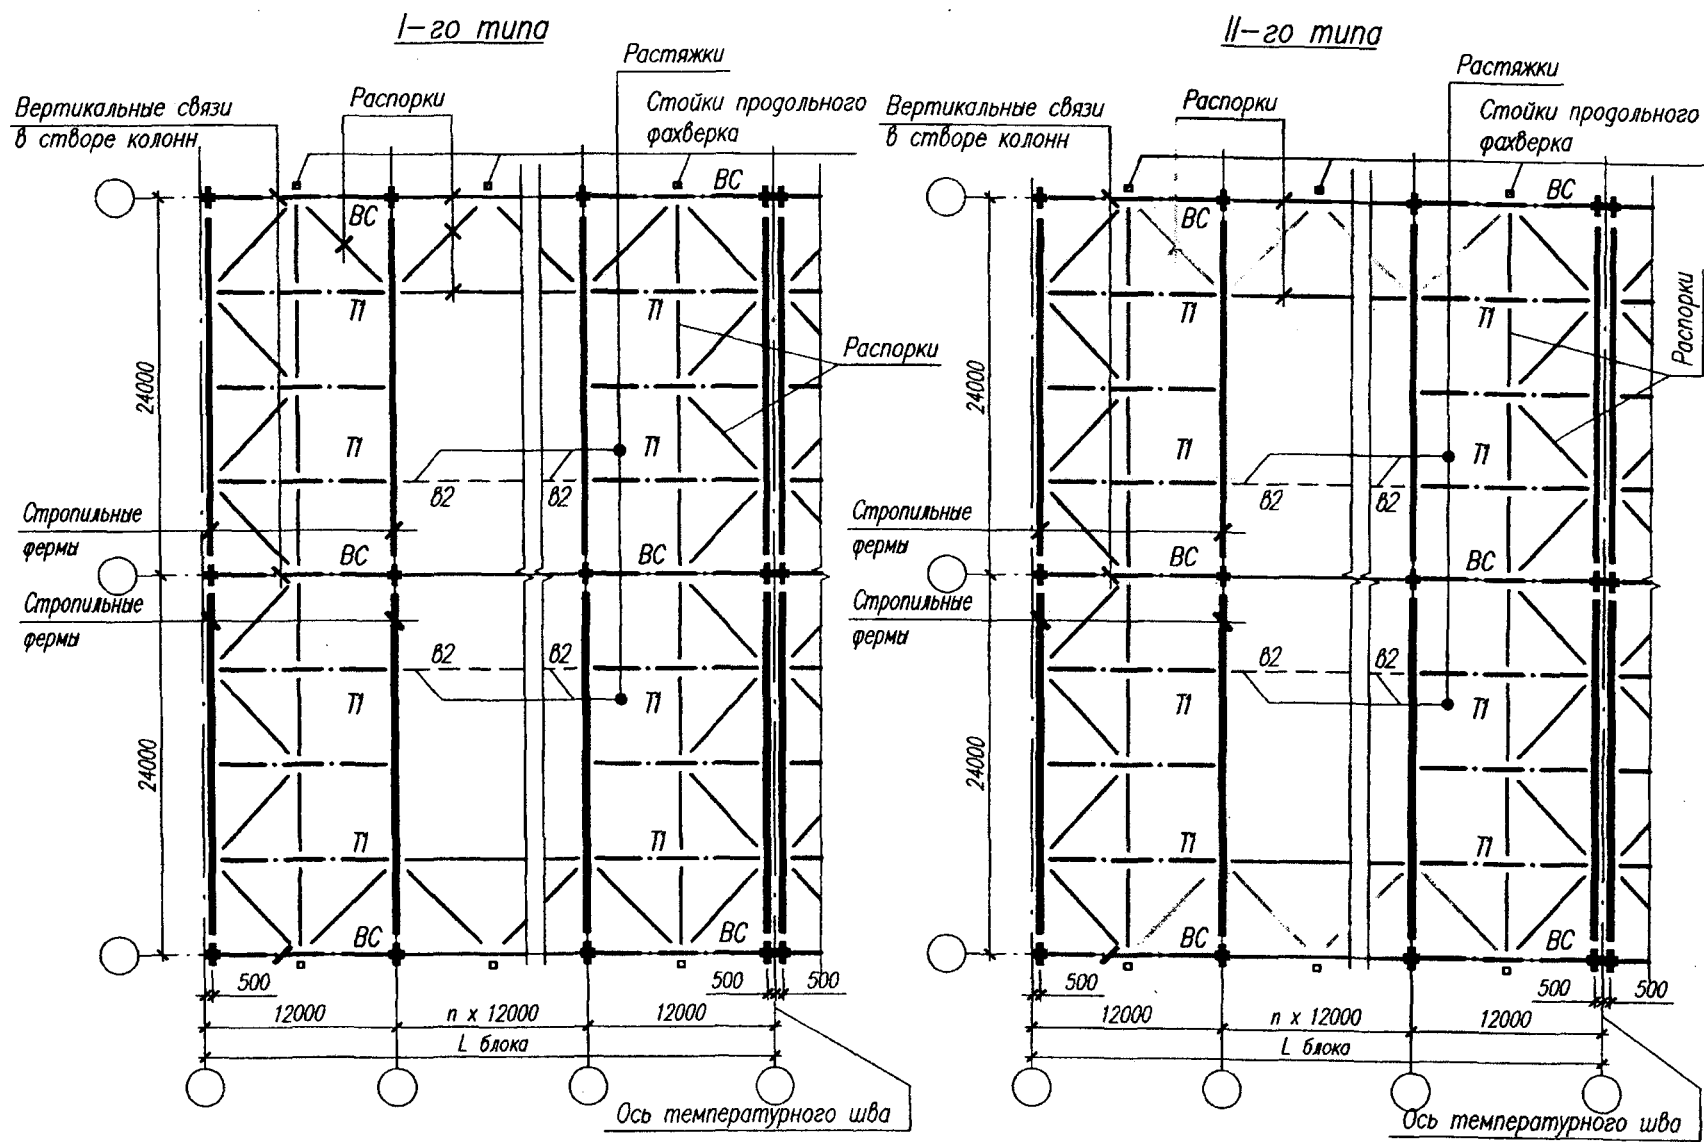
Схема расположения связей по нижним поясам стропильных ферм (шаг ферм 12 м)
